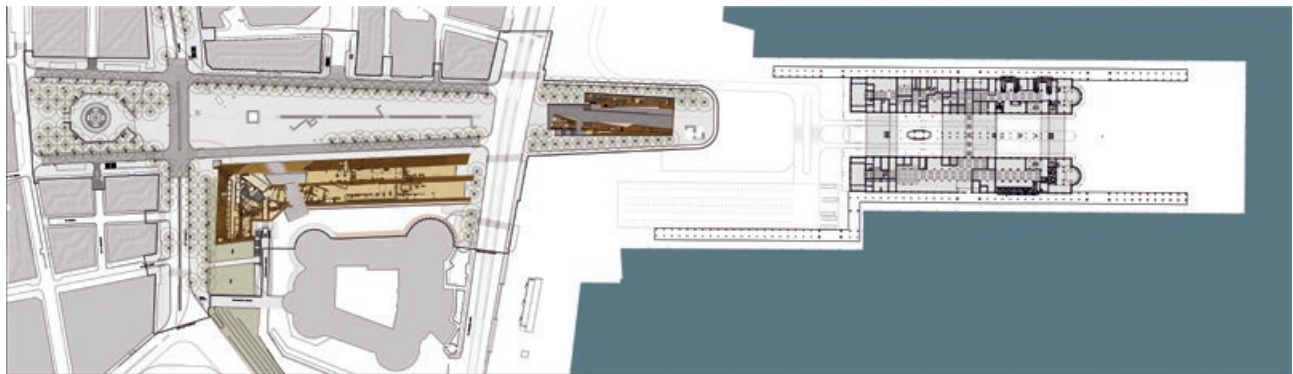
Planimetria generale dell'intervento alla quota stradale.
